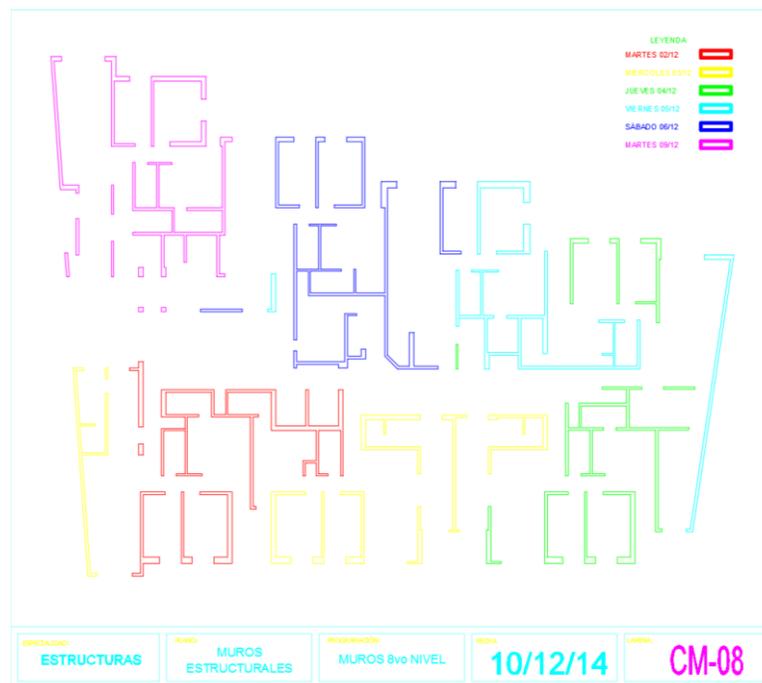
Sectorización de Muros Nivel 8. Fuente: Elaboración Propia
